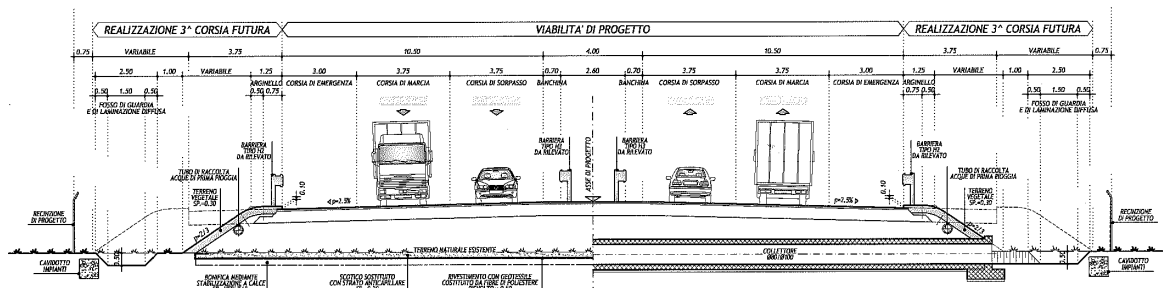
SEZIONE TIPO IN RETTILIFEO
